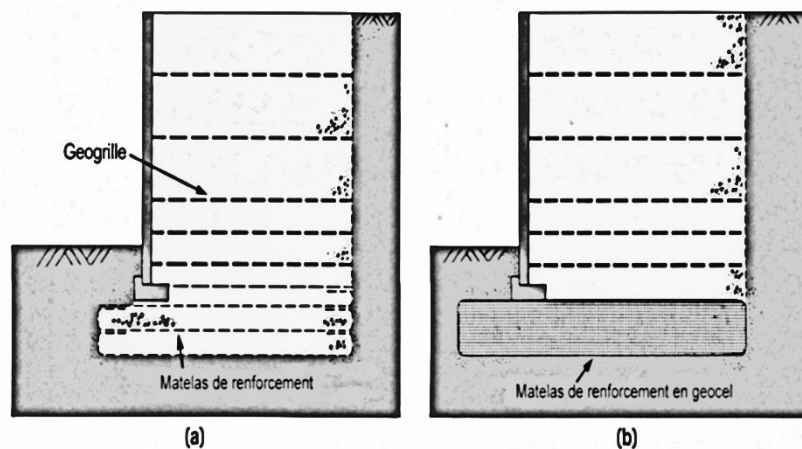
Renforcement de sol de fondation en géogrilles ou en géocell
